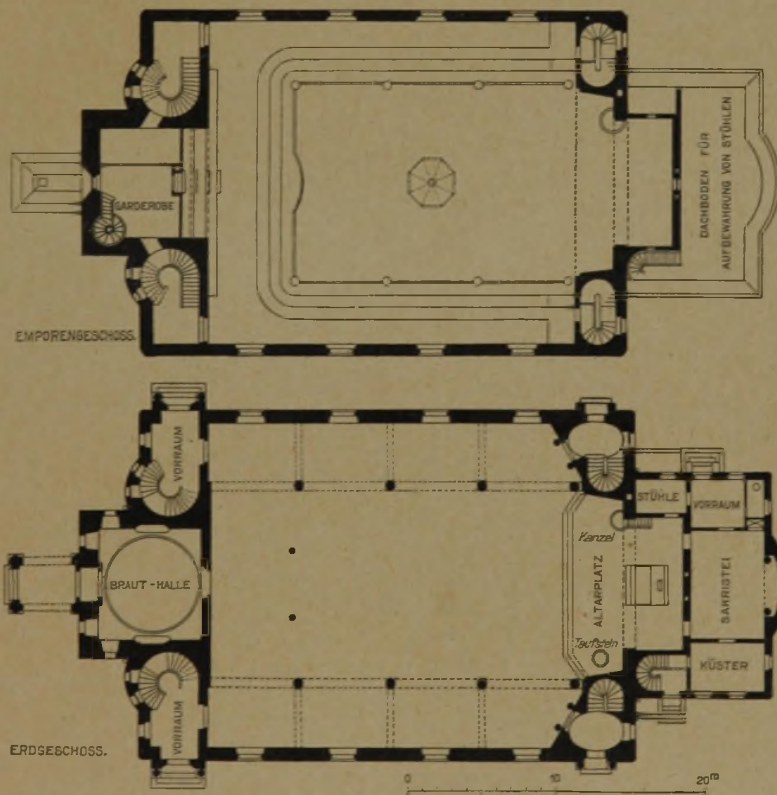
und 7. Grundrisse im Erd- und Emporengeschoß.
